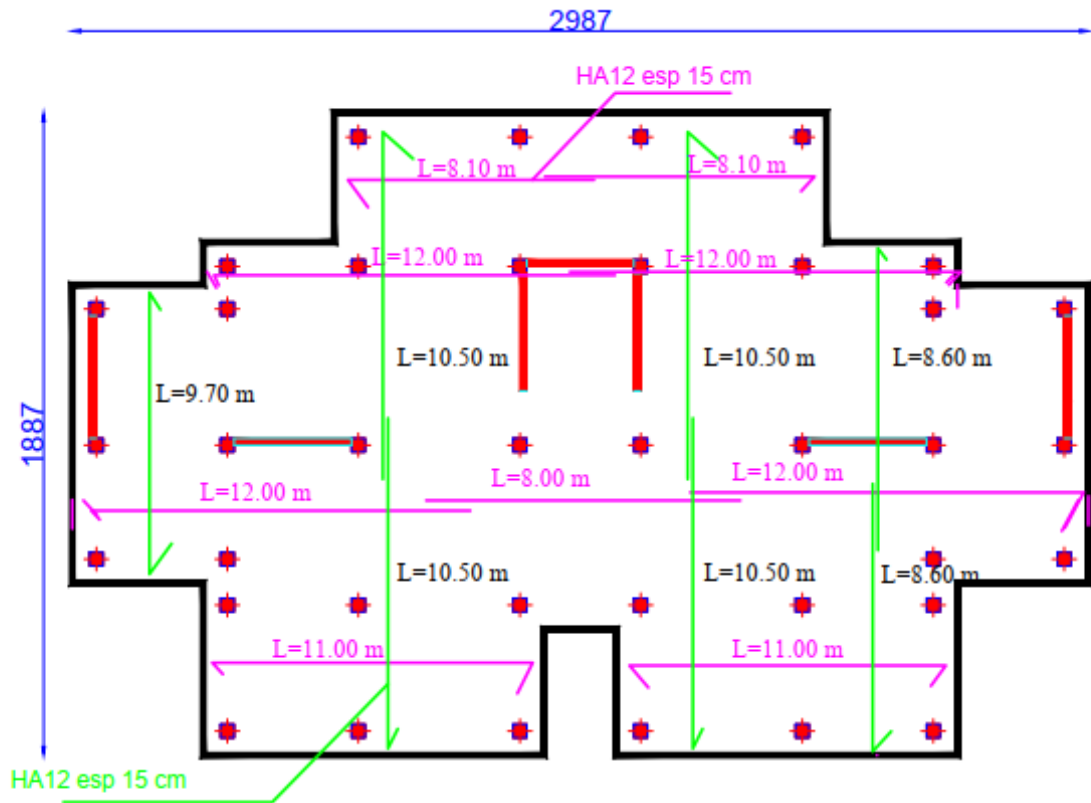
Plans de Coffrage et Ferrailage du Radier La nappe inférieure
